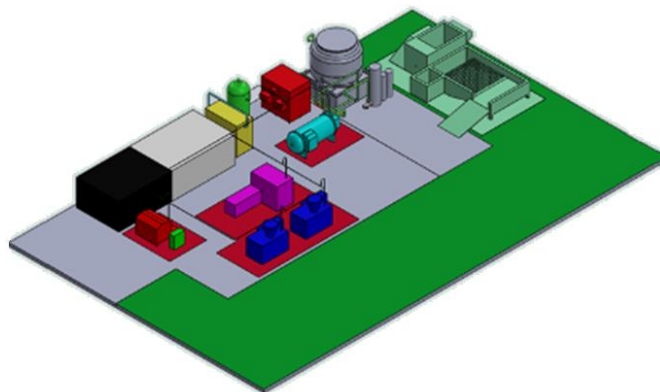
Vista isométrica de máquinas y servicios en SolidWorks
